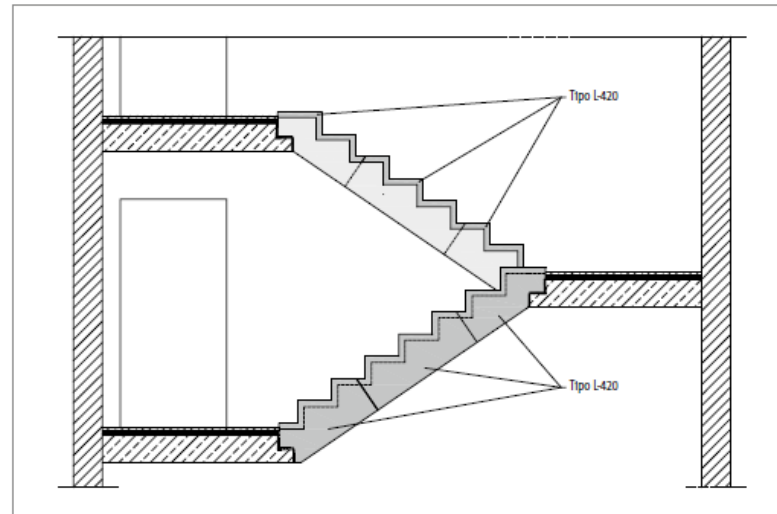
Schöck Tronsole® tipo L-420, disposizione dell'elemento; sezione A-A
